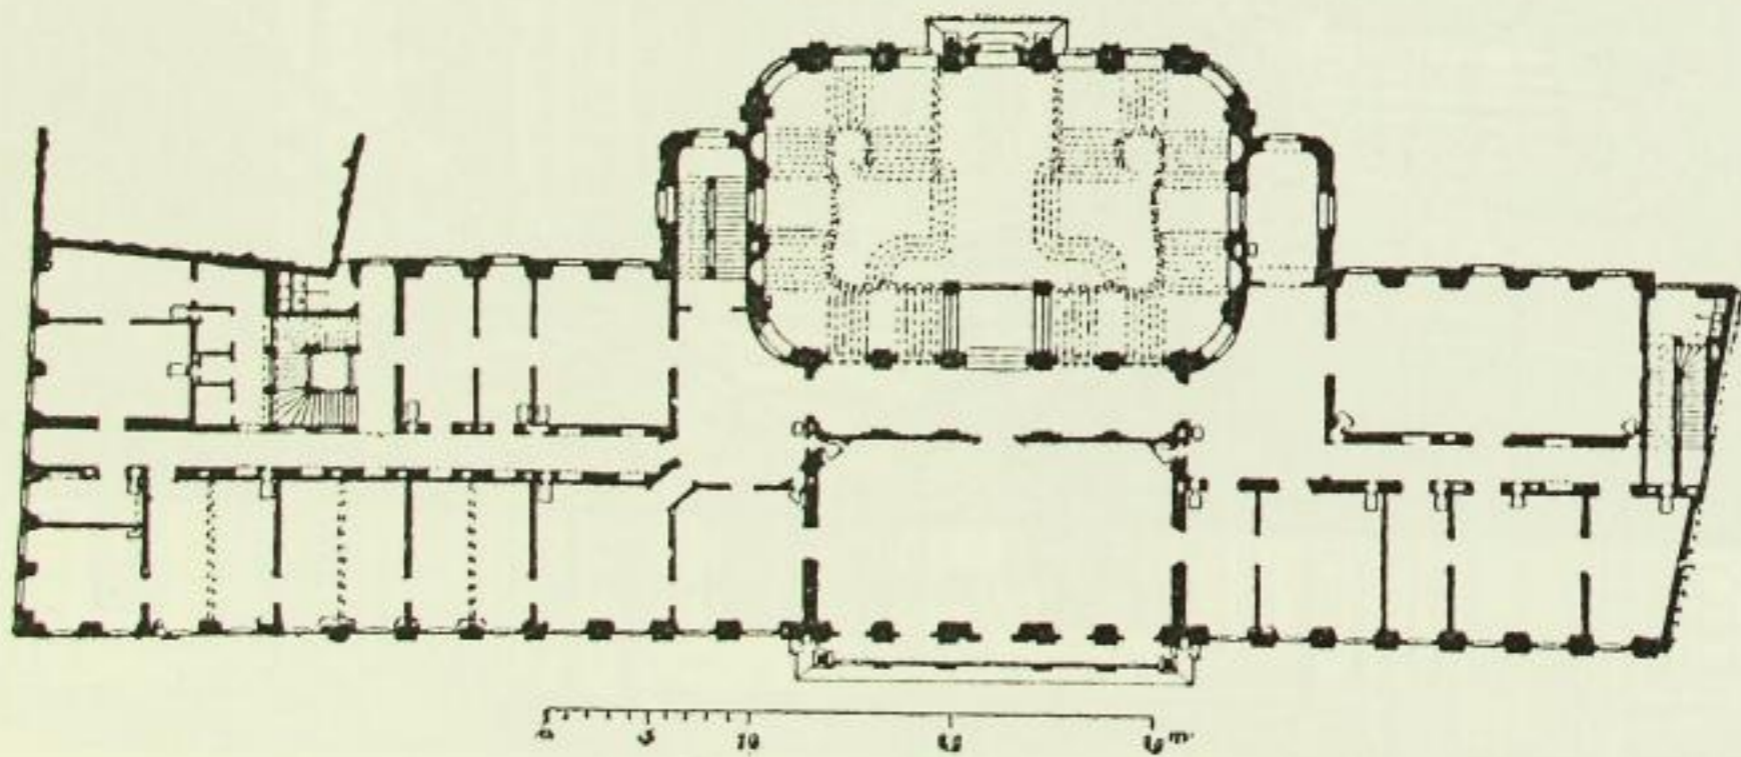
Landhaus, Grundriss des Hauptgeschosses.
